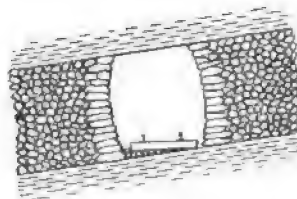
Abbaustrecke mit ausgebauten Bergemauern.
